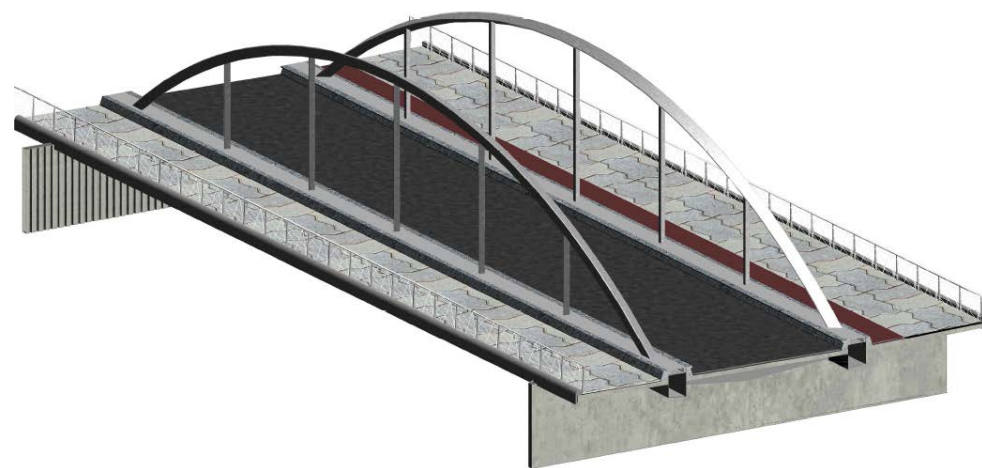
Modelo 3D de la solución adoptada. Elaboración propia con AutoCAD
